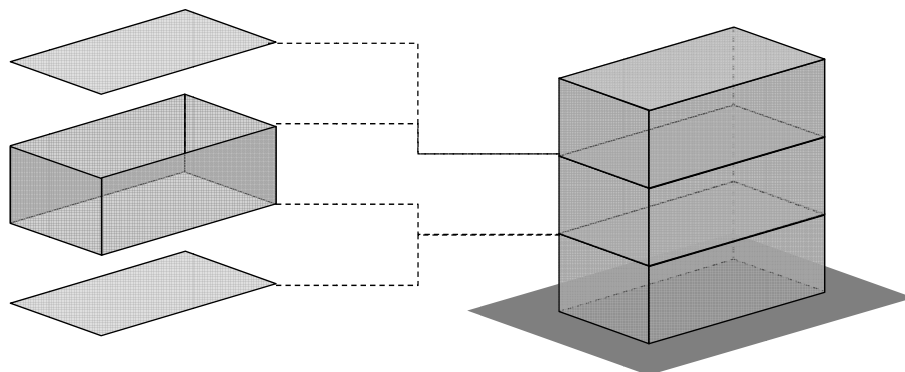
Struttura di un edificio formata da elementi strutturali piani (pareti e solai)
